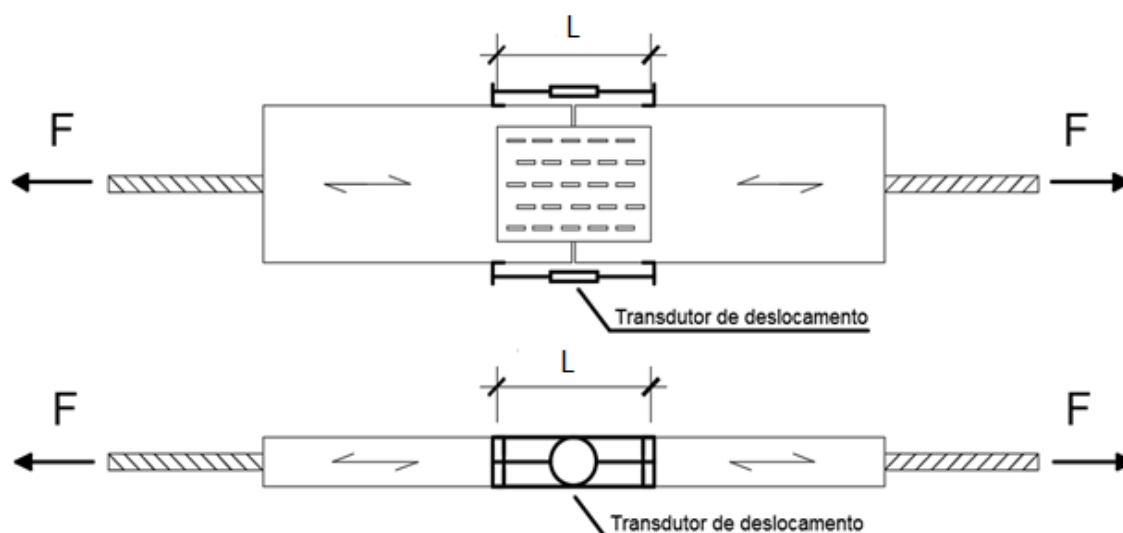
Figura esquemática do ensaio de rigidez da ligação.
